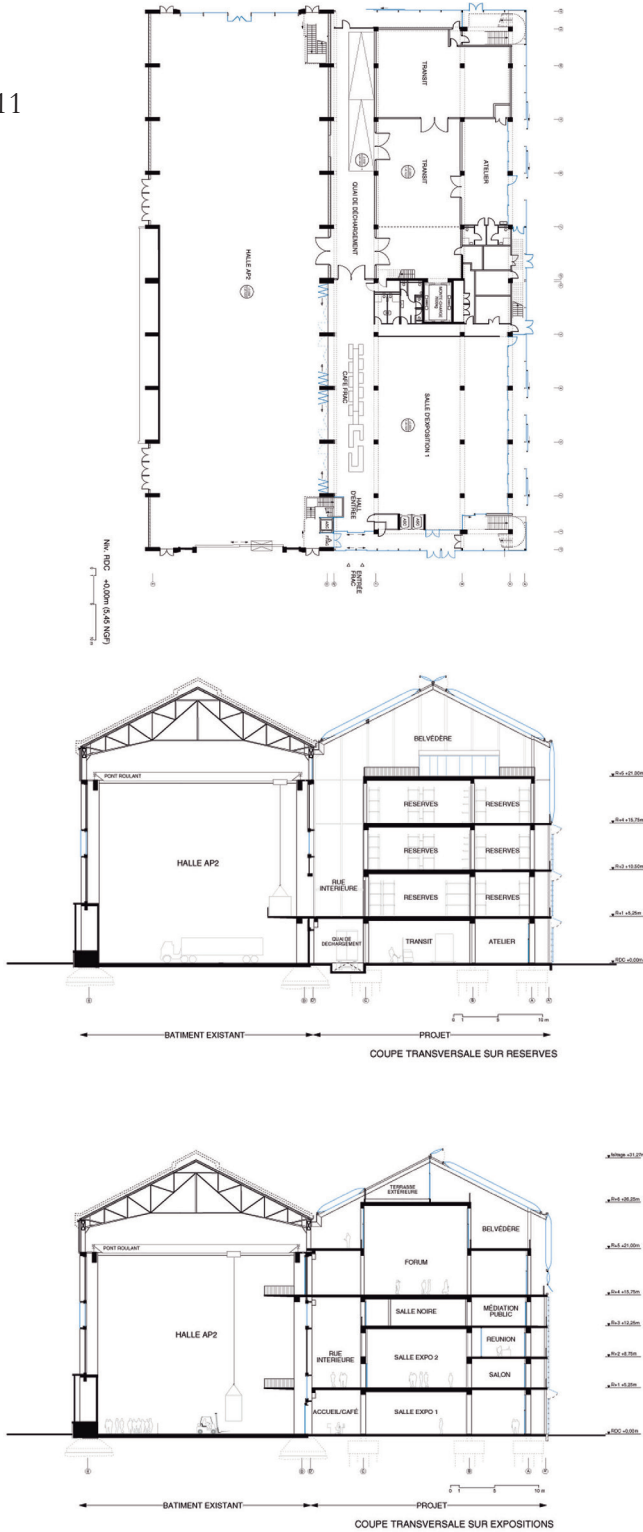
, 6, 7, 8. Planimetría edificio Frac.
